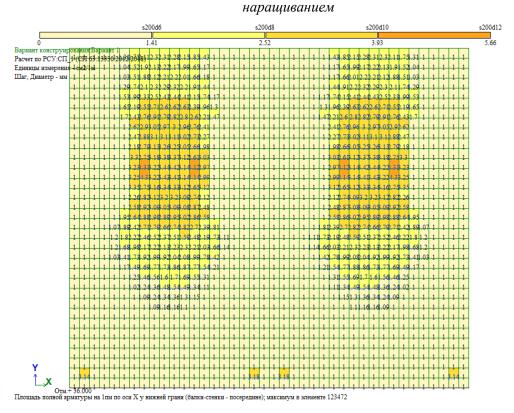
Требуемое нижнее армирование перекрытия по X, после усиления двусторонним наращиванием
